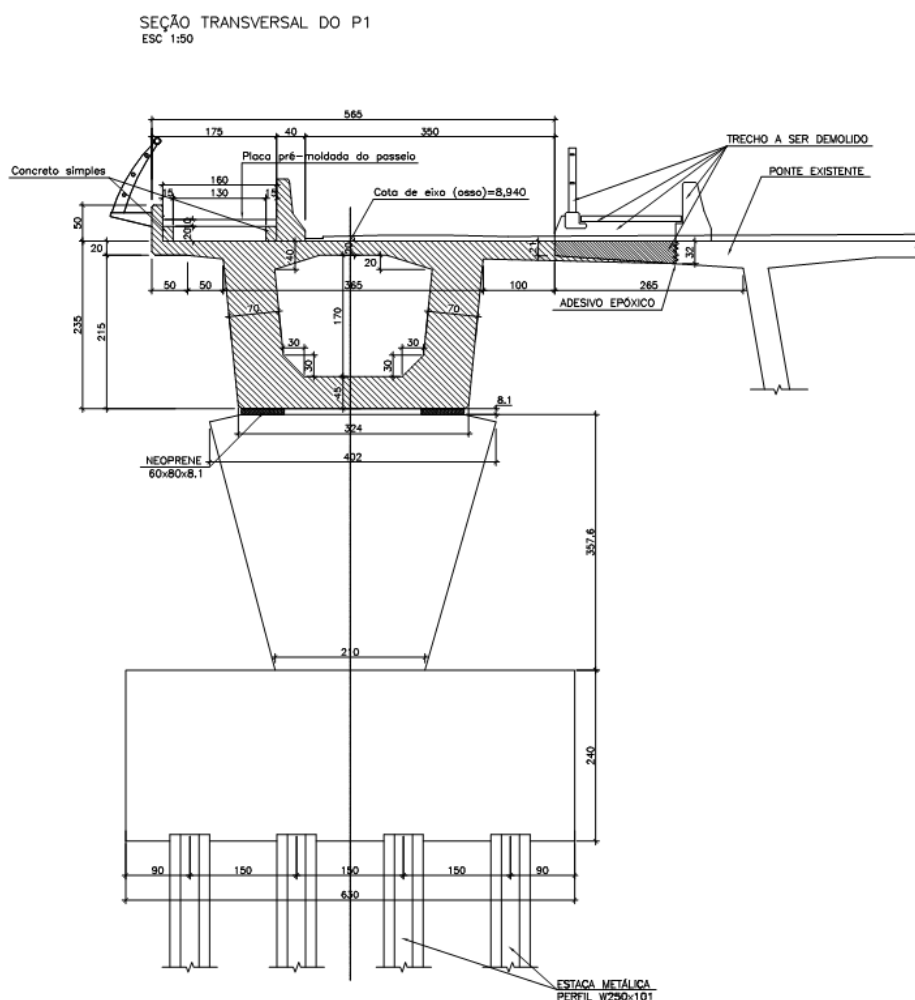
Seção transversal do tabuleiro, pilar e bloco de fundação no apoio 1.
